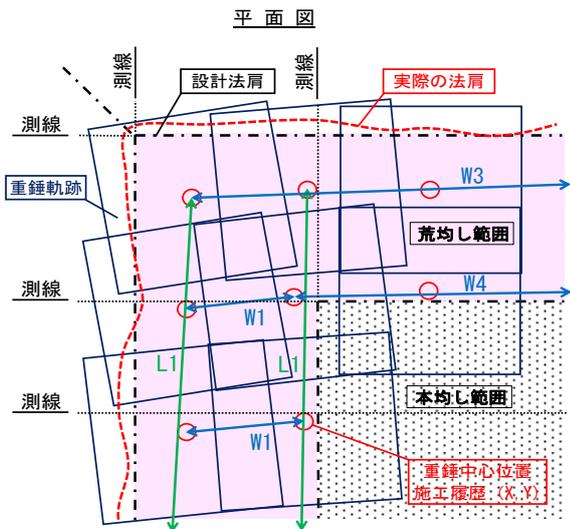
施工中の施工履歴データによる捨石荒均しの距離計測
